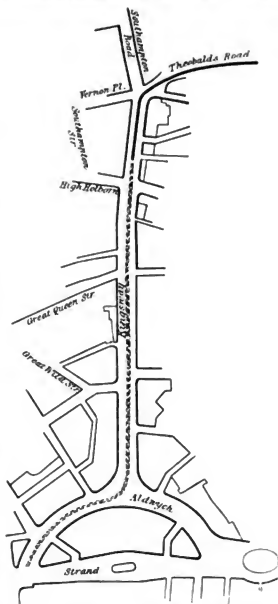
Lageplan der Unterpflaster-Straßenbahn Holborn-Strand.
